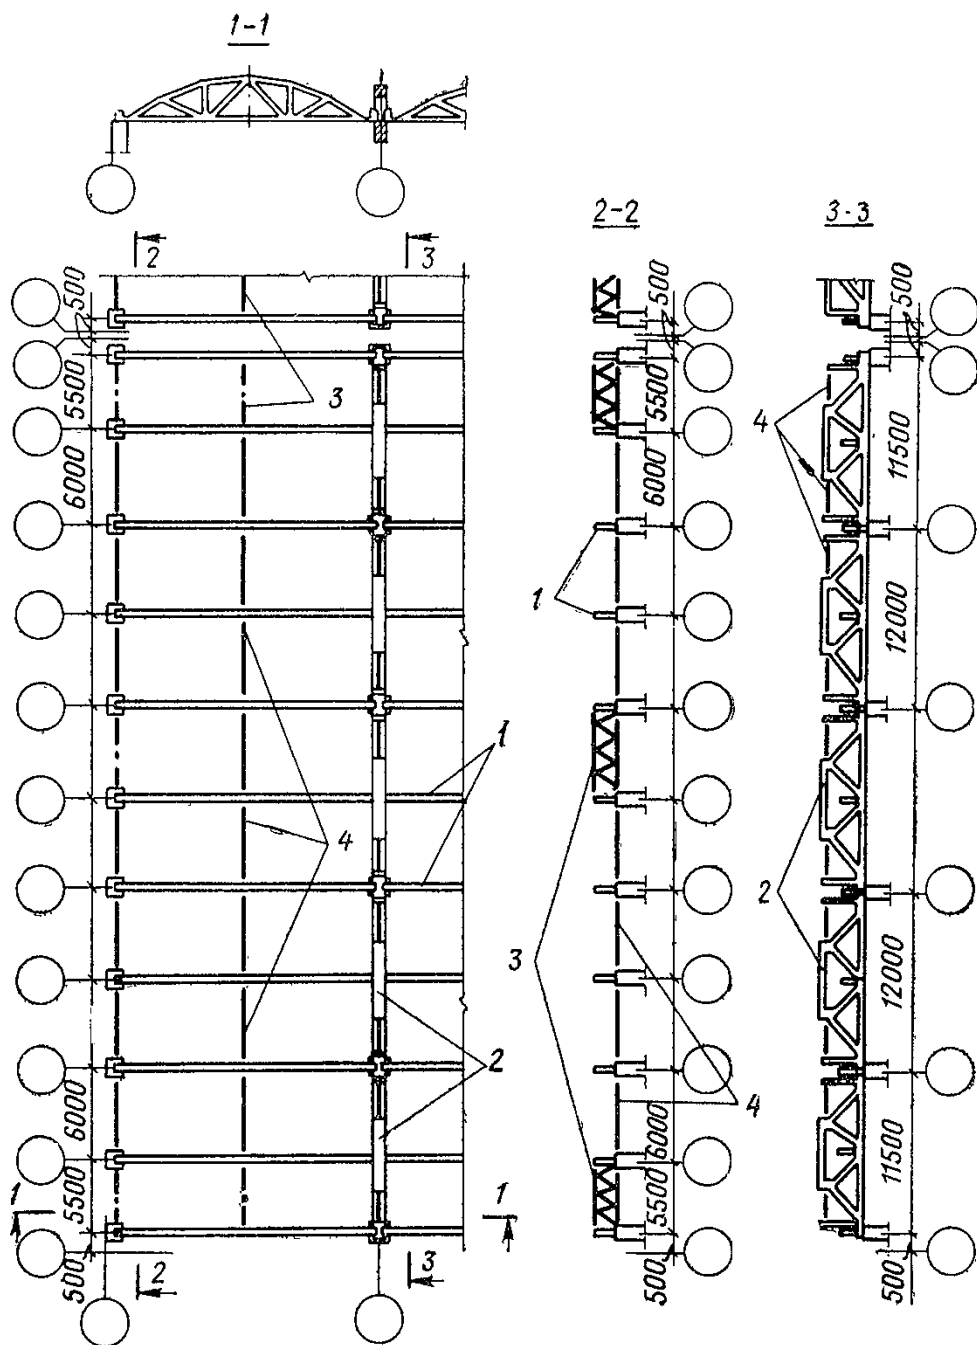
Пример расположения связей покрытия с фермами (при скатной кровле) в зданиях с шагом крайних колонн 6 м и средних 12 м при расчетной сейсмичности 8 баллов
